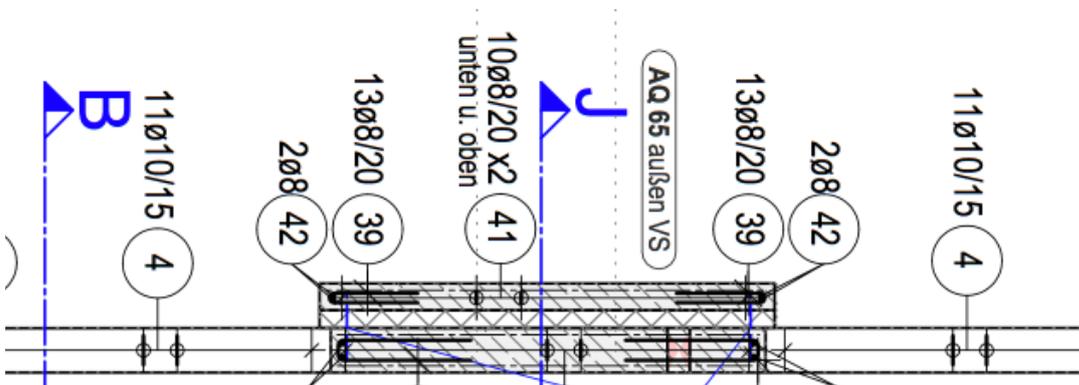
Bewehrungsplan im Grundriss der Fassade 9
